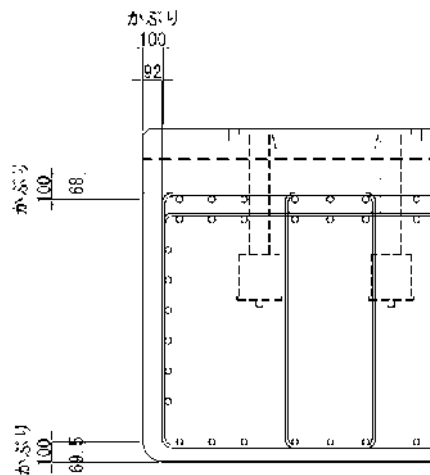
標準的な梁のかぶり（要領 図-3.66）
